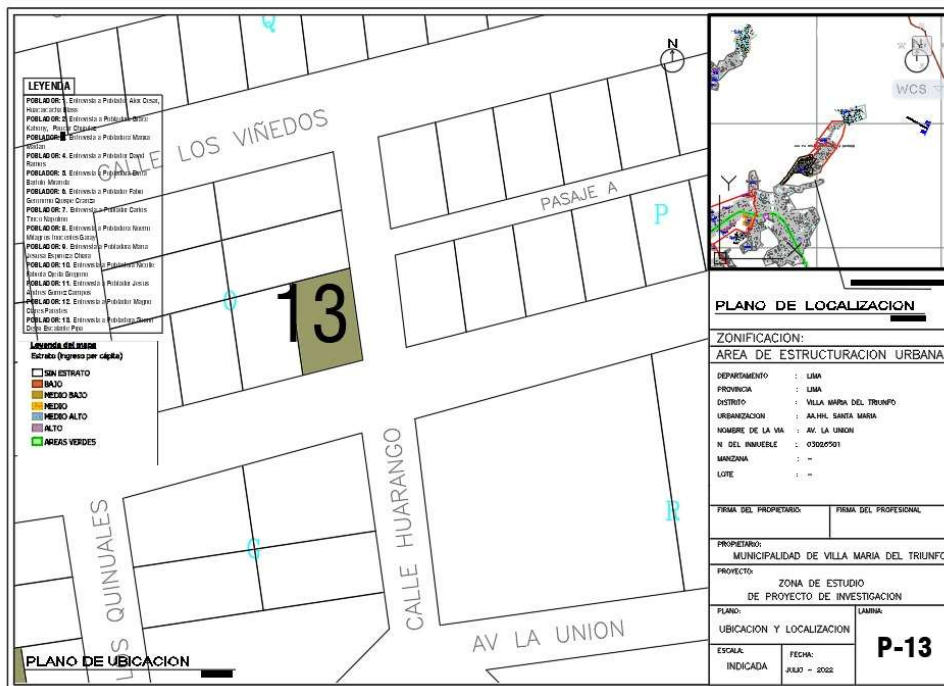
Plano de Ubicación de Casa del Señor Magno Clares Paredes
